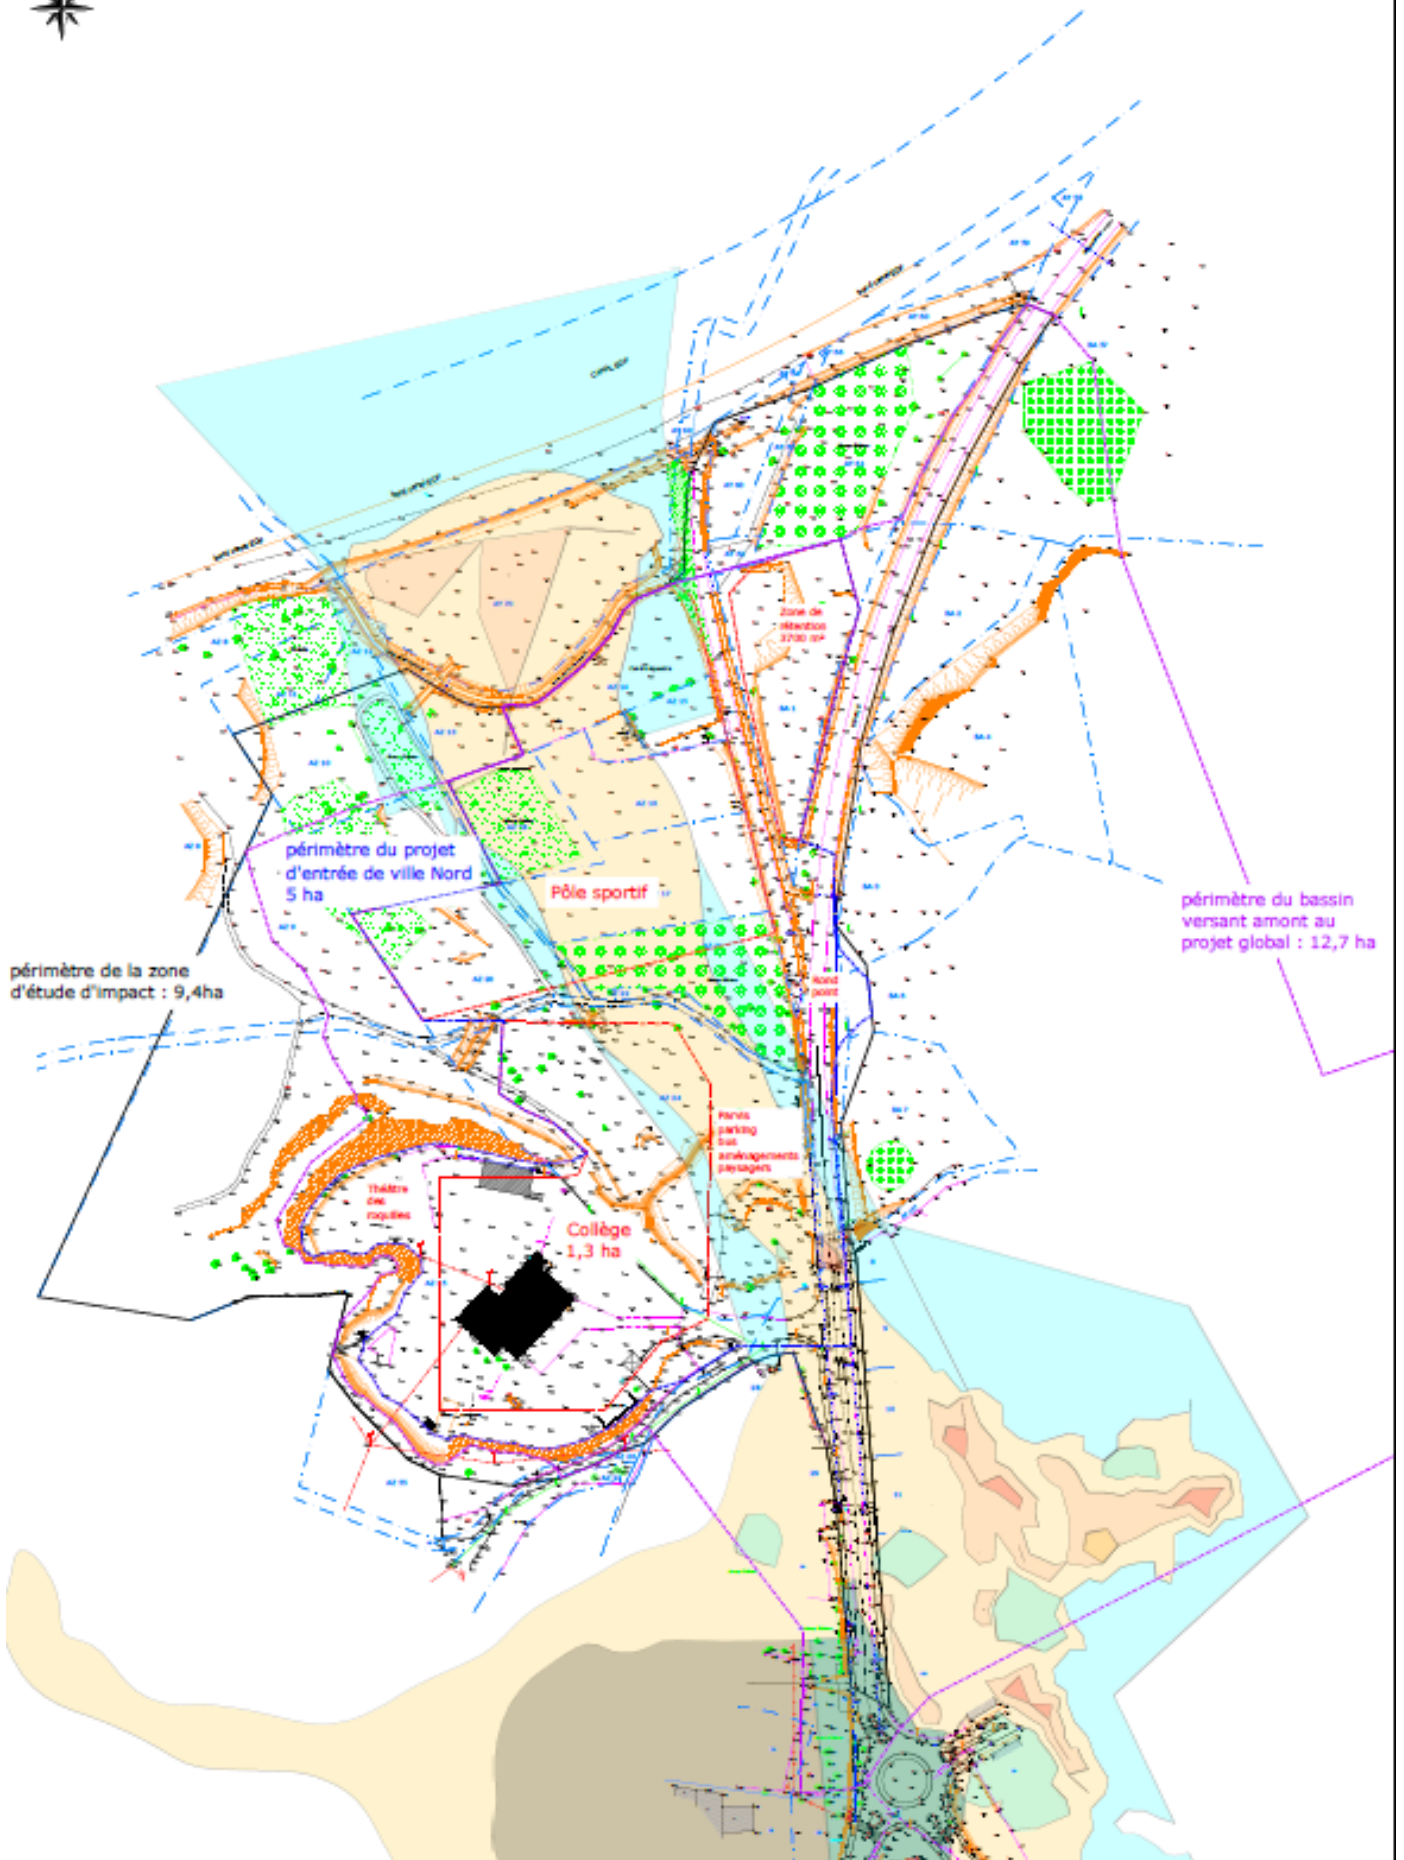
Périmètres du projet sur fond de plan topographique (source SERI)
